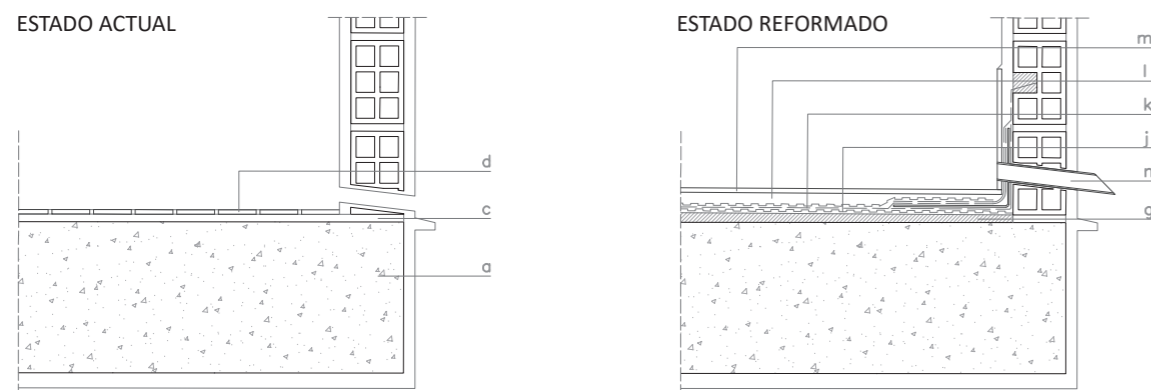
Detalle constructivo. Impermeabilización galerías en encuentro con aliviadero. [Tabla 2]
